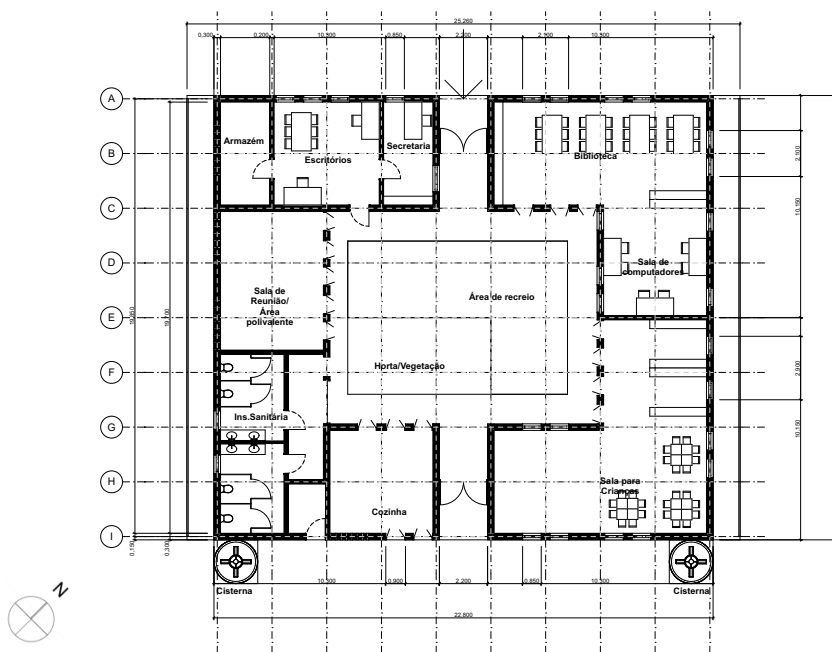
Planta Baixa do Centro comunitário (Fonte: Autora)
